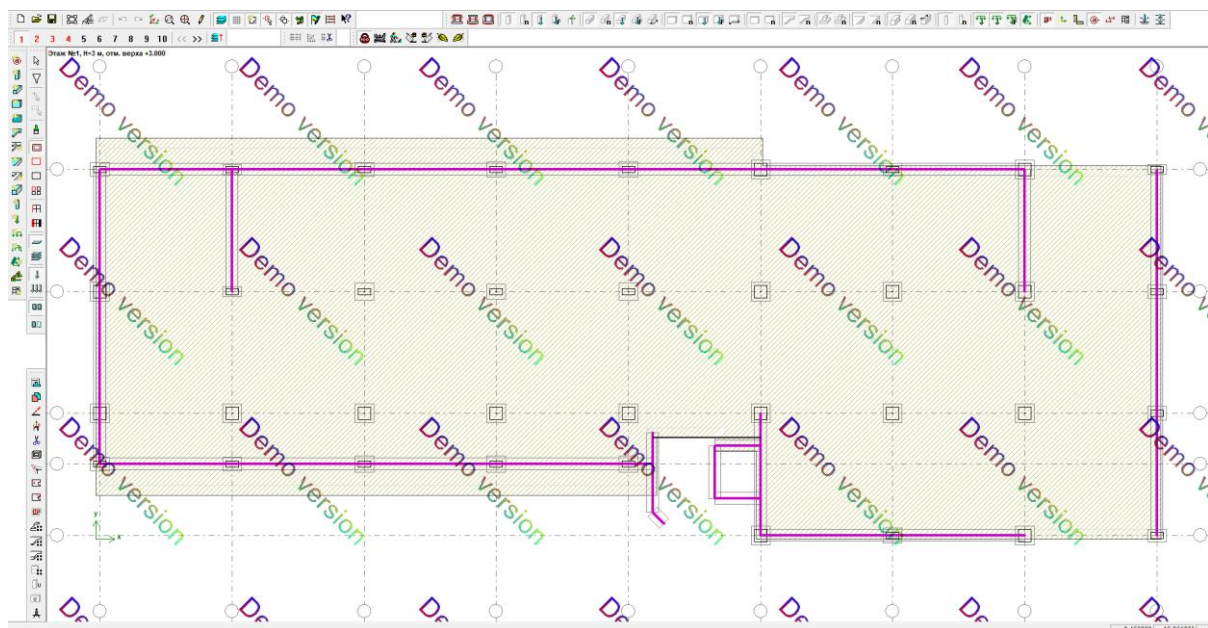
План компонування елементів конструкції підземного поверху
